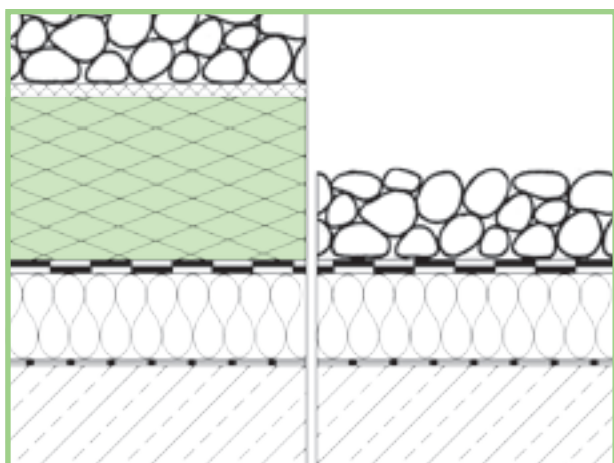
A sinistra nuova struttura di un tetto plus, a destra vecchia struttura del tetto caldo.
